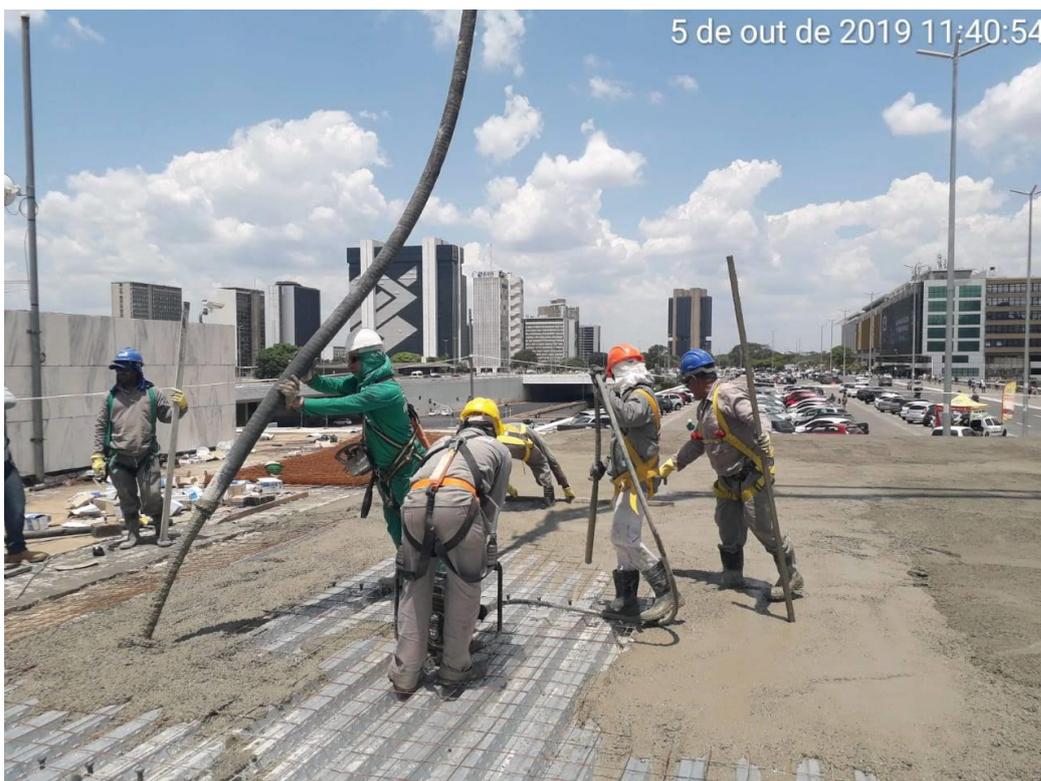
Concretagem da laje em Steel Deck na Plataforma Superior.
